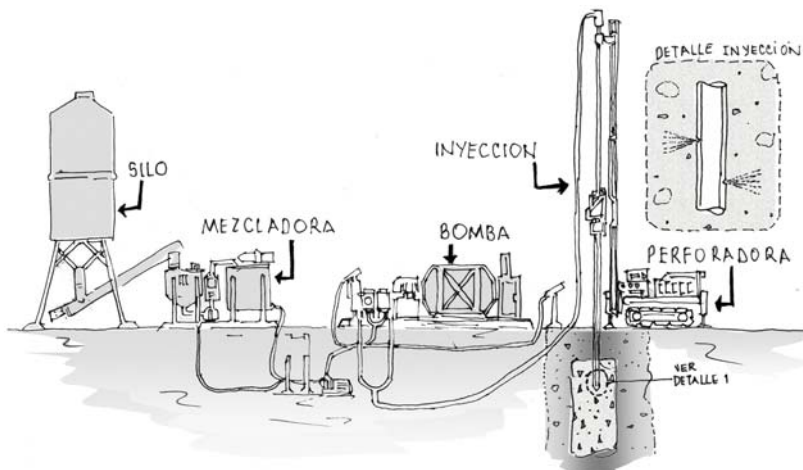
Instalaciones complementarias para la ejecución de jet grouting.
